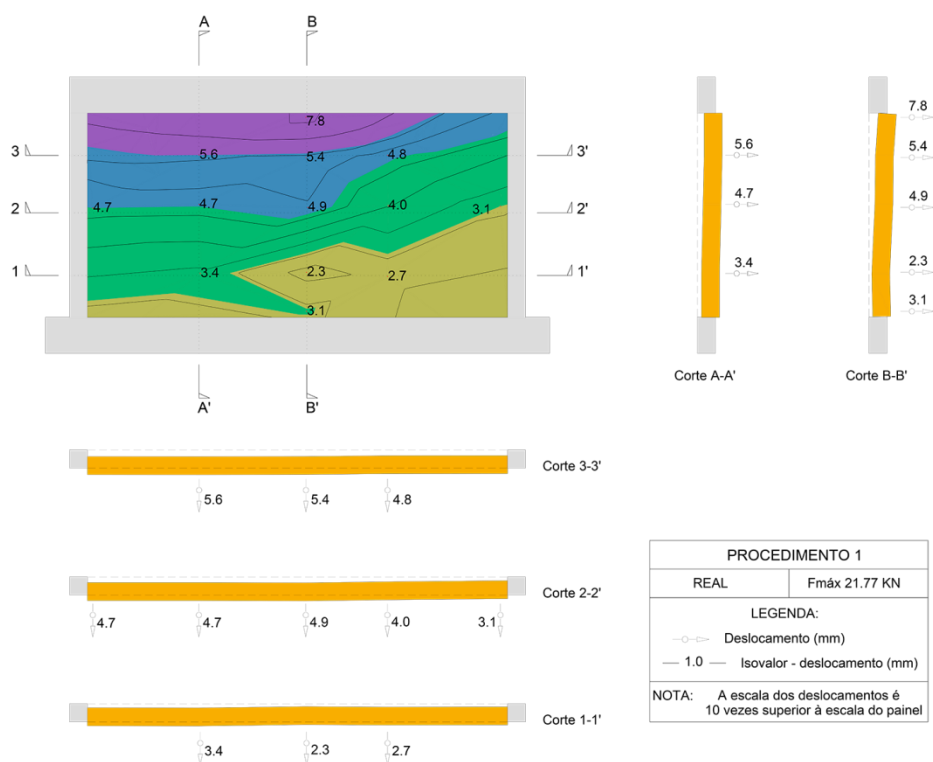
Isovalores da parede ensaiada - Procedimento 1. Ensaio fora do plano, Wall_RAR_02.
